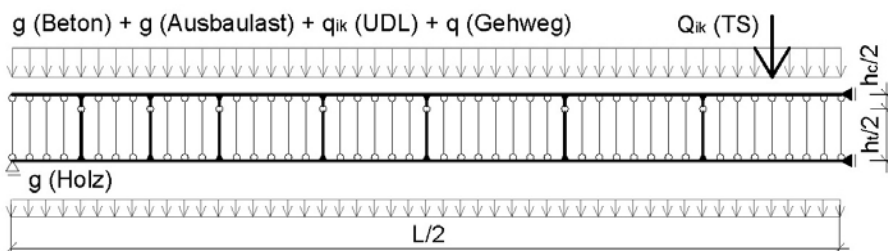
Stabwerksmodell zur Berechnung einer Holz-Beton-Verbundbrücke
